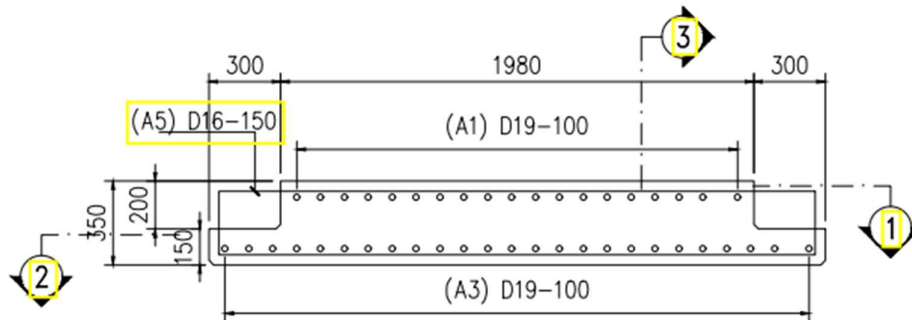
Detail Potongan 1 *Half Slab* Tebal 25 Cm
